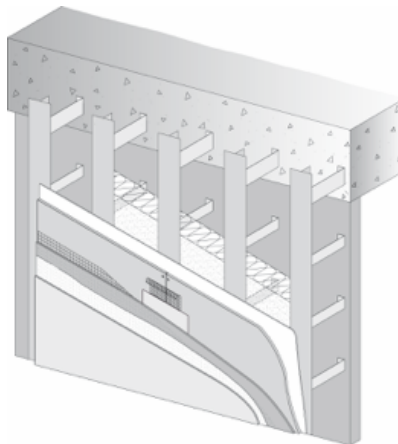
Sistema fachada ventilada con placa Aquapanel. Fuente: Knauf.
